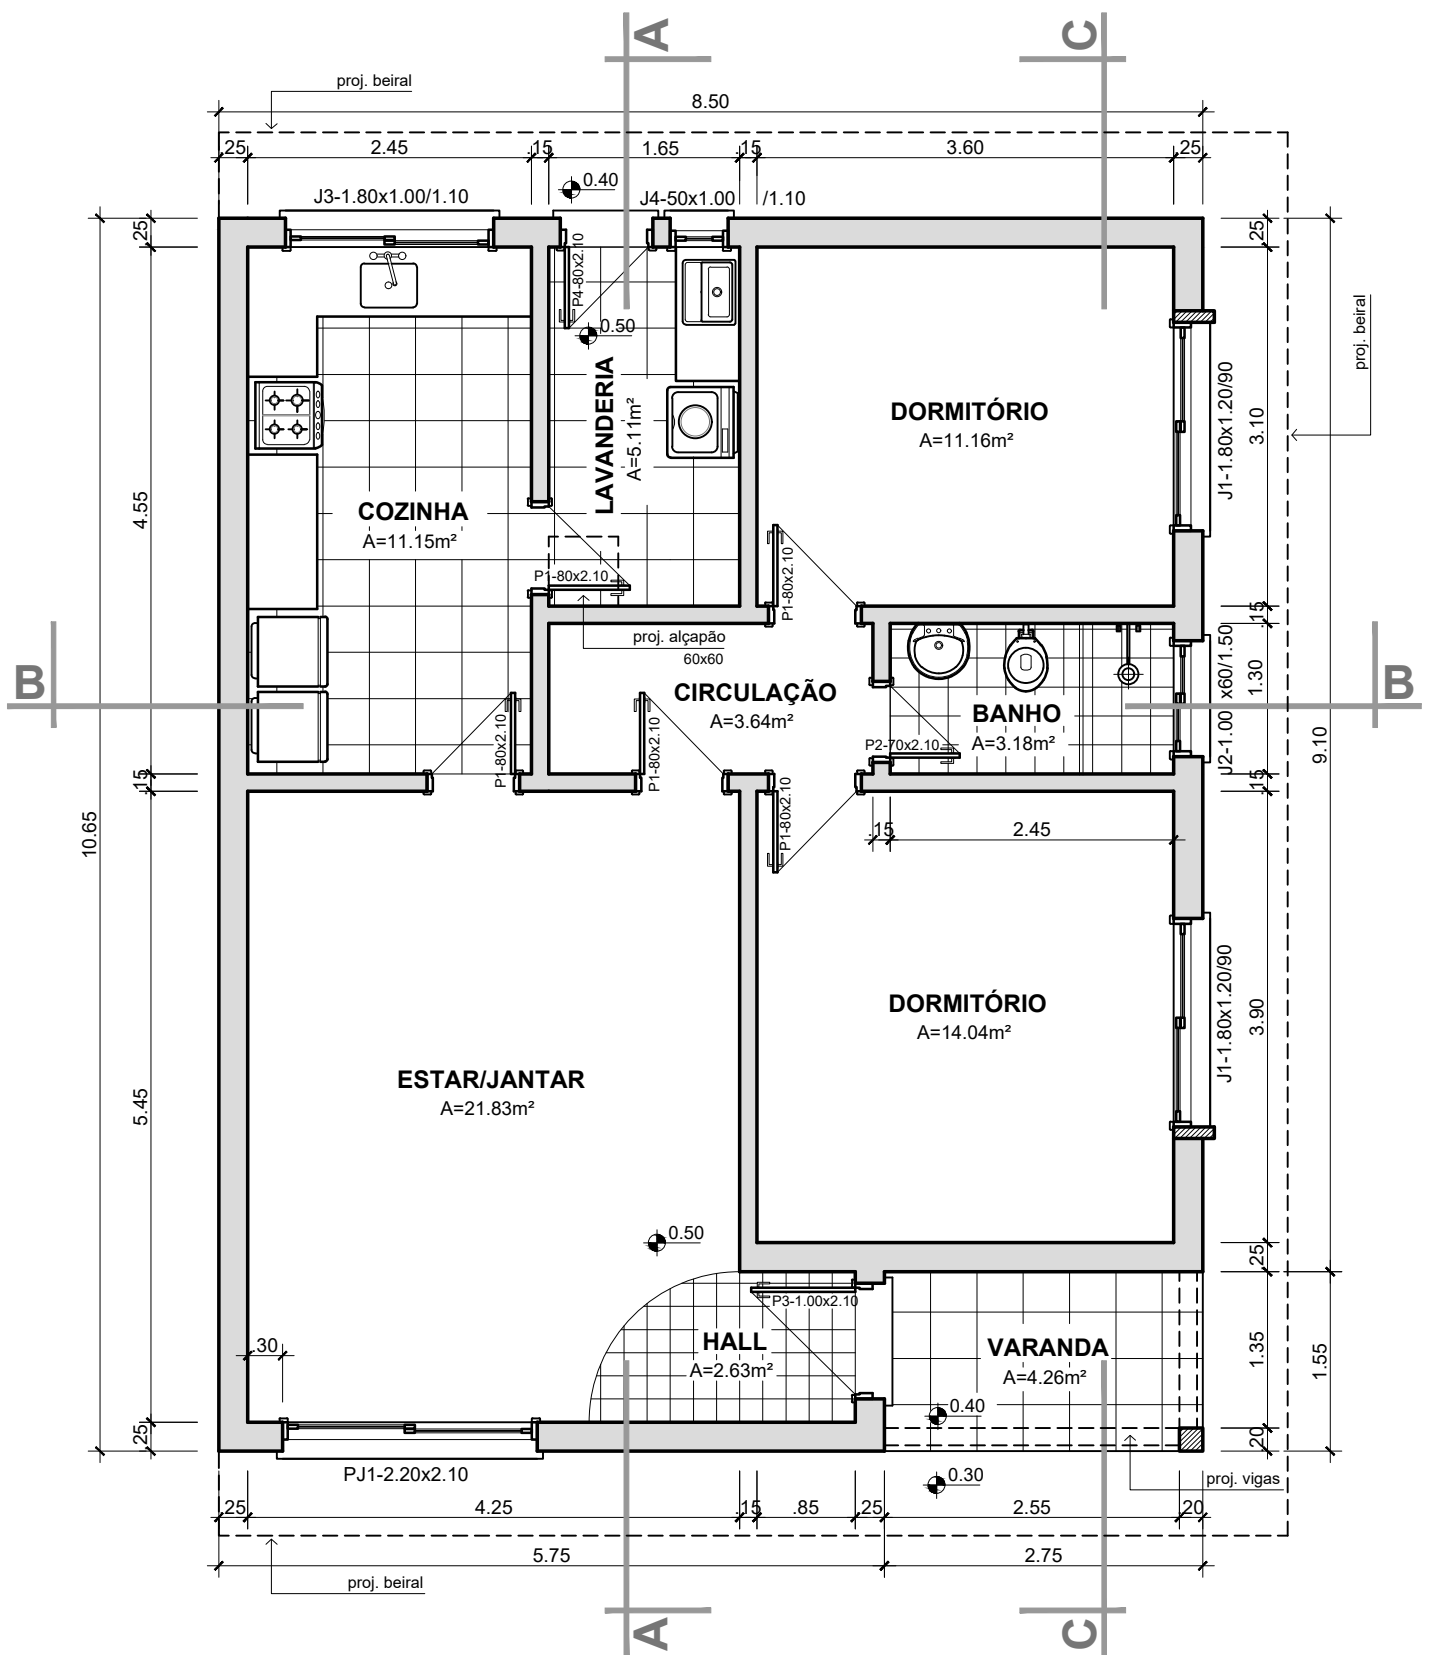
Exemplo de uma planta baixa. Fonte: Autor
